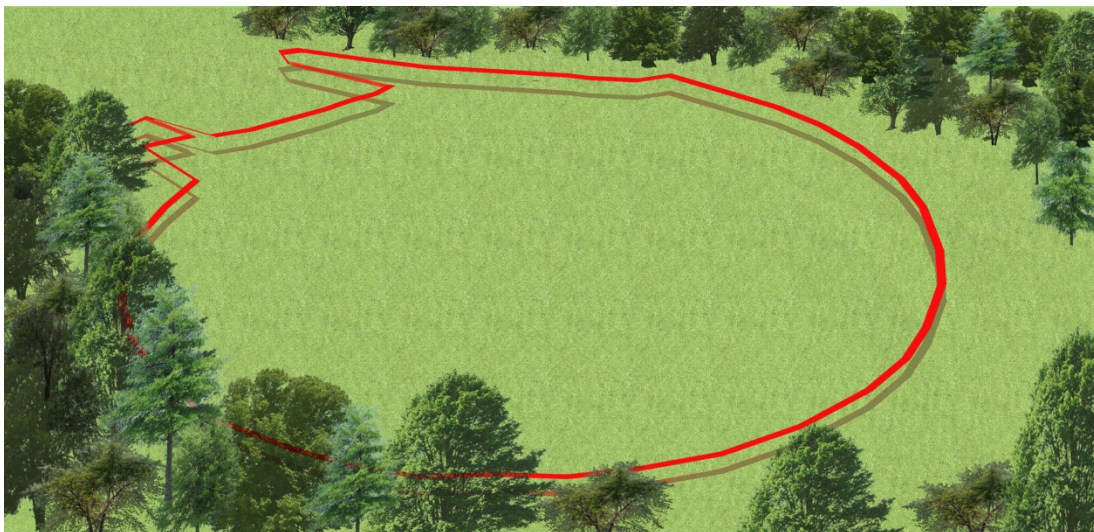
FASE DI CANTIERE – TRACCIAMENTO
